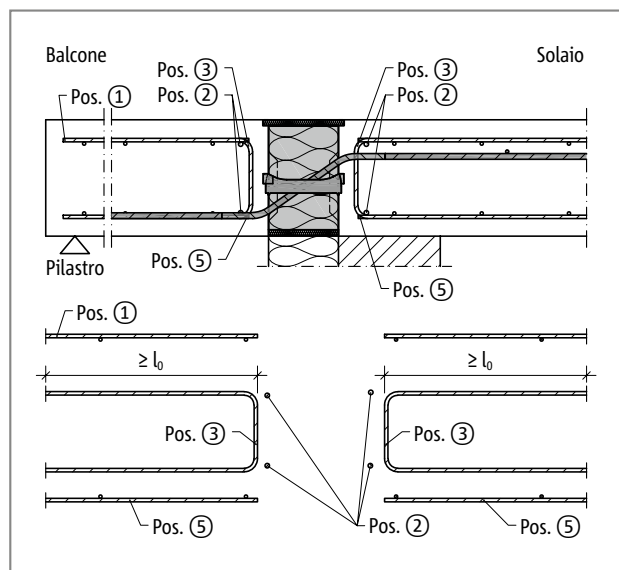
Schöck Isokorb® XT tipo QL-V5 a QL-V8: armatura in opera
